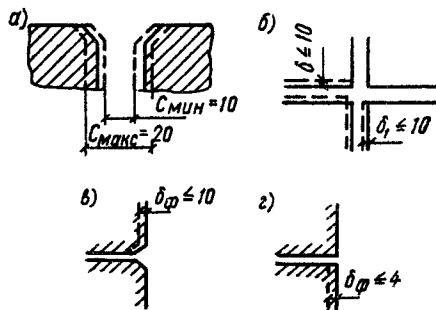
Допускаемые отклонения при монтаже стеновых панелей
